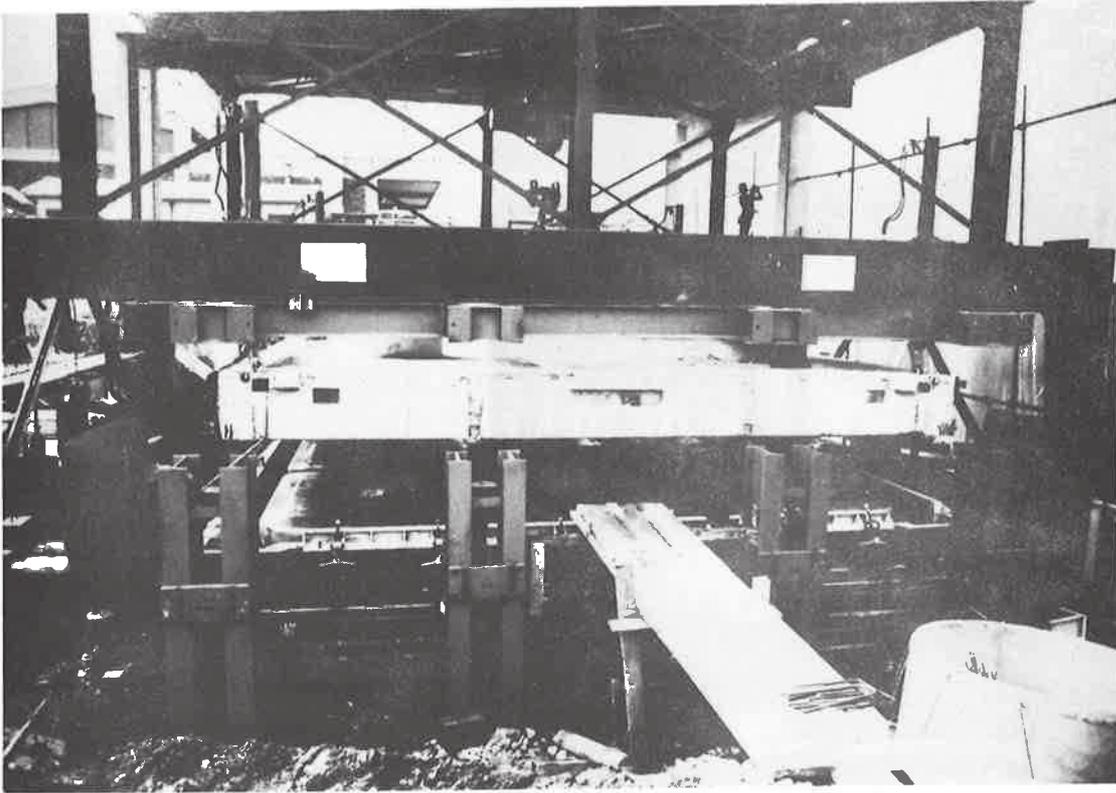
sollevamento con martinetti e varo trasversale con cavalletto - rif. VI
